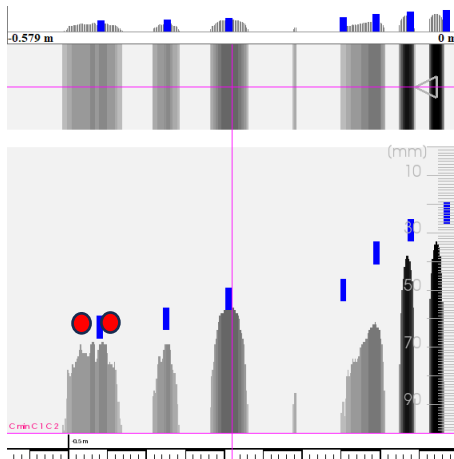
Poutre Pt03 – Travée 3 côté P2
